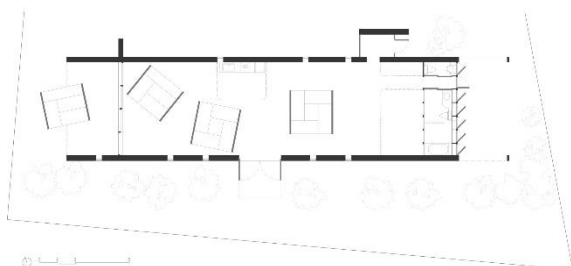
Planta Naked House, Shigeru Ban. Saitama. Japón. 2000. Elaboración propia.
